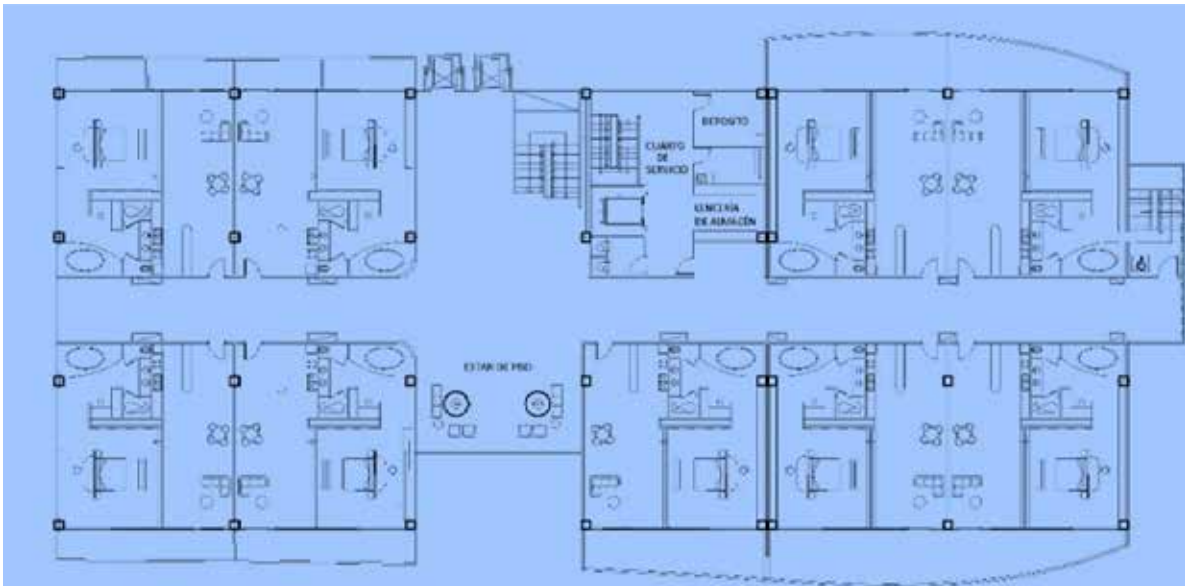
Planta Tipo Suite Autora: Cáceres (2017).
